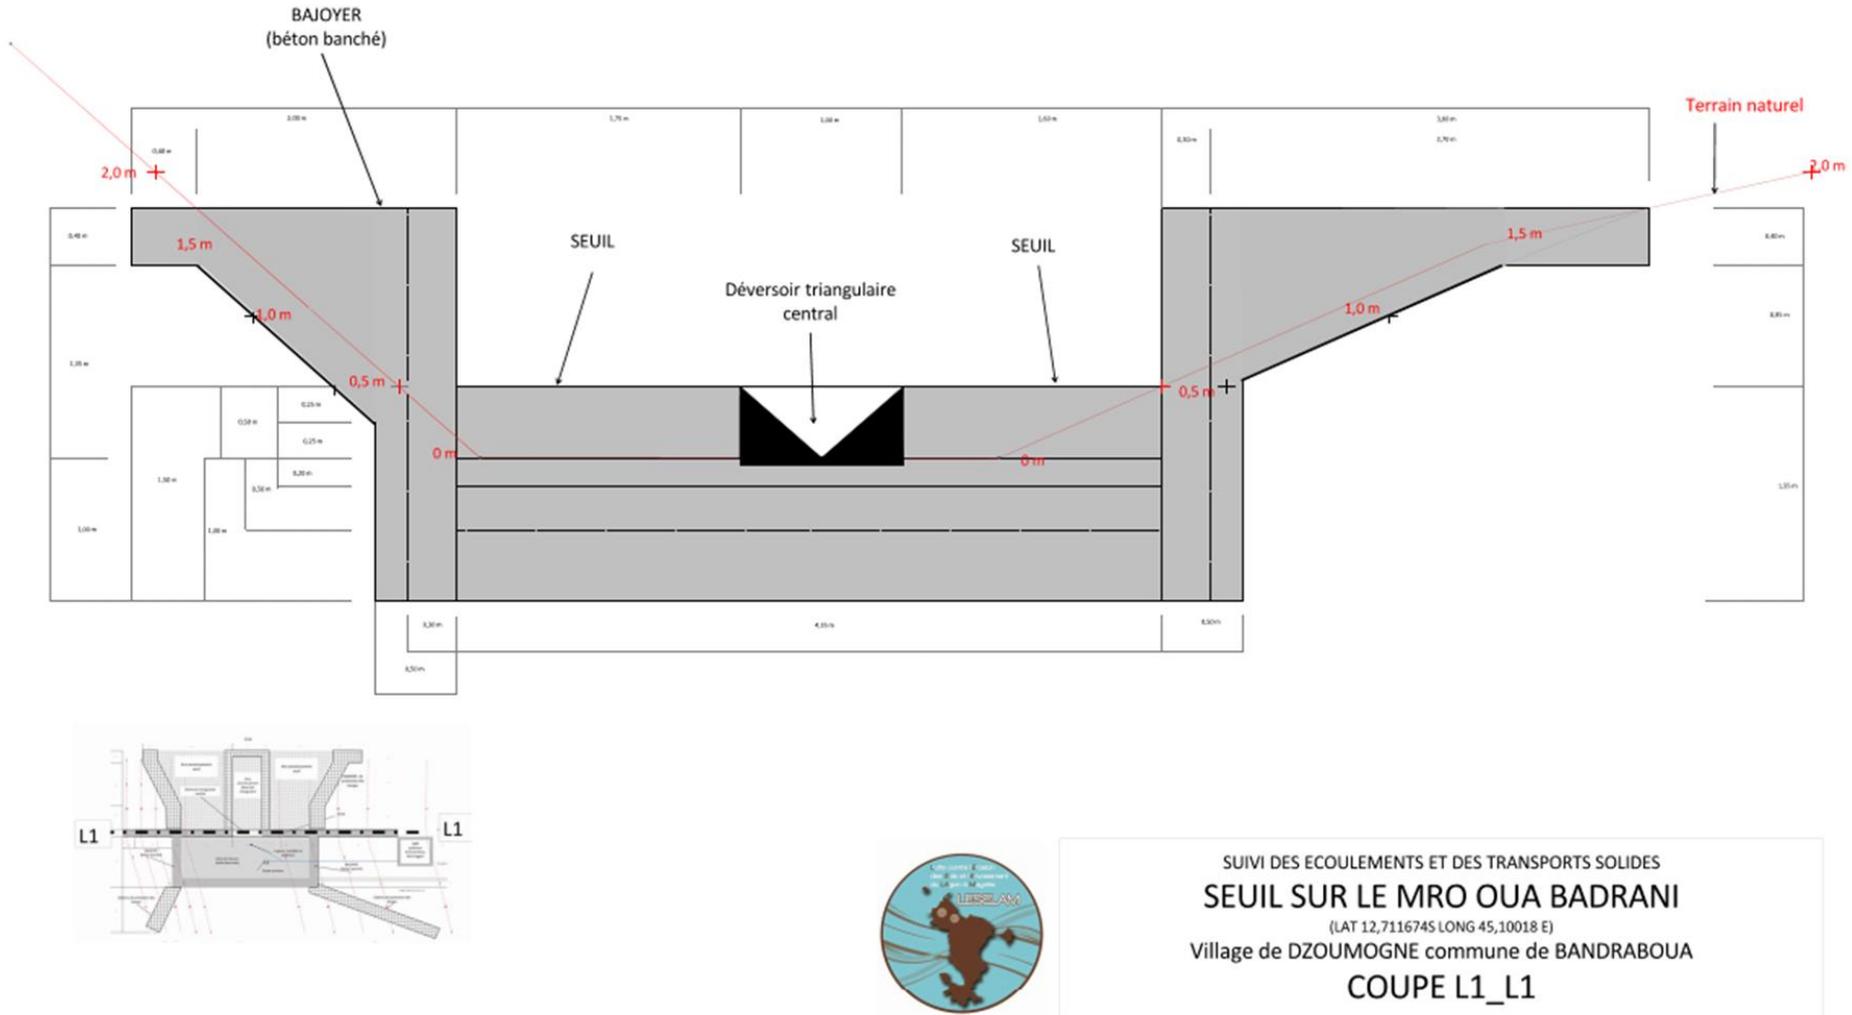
Coupe transversale au niveau du seuil (Rive droite rive gauche) (L1-L1)
